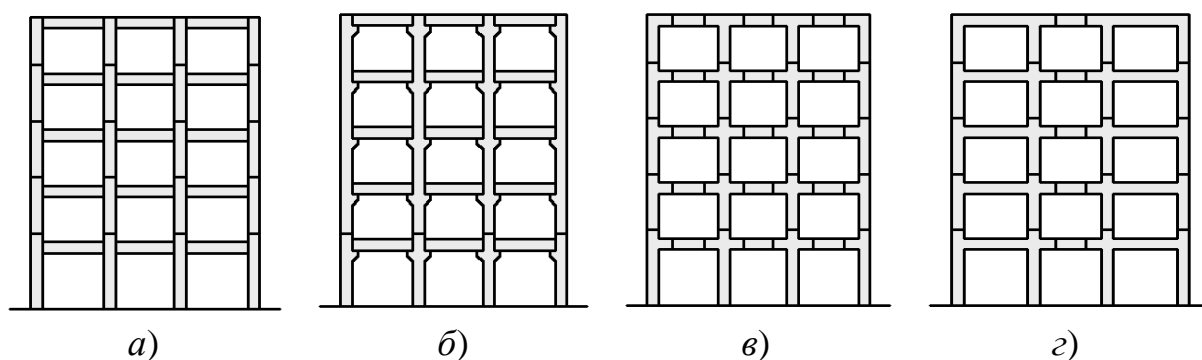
Схеми членування рам багатоповерхових каркасних будівель на окремі елементи:
